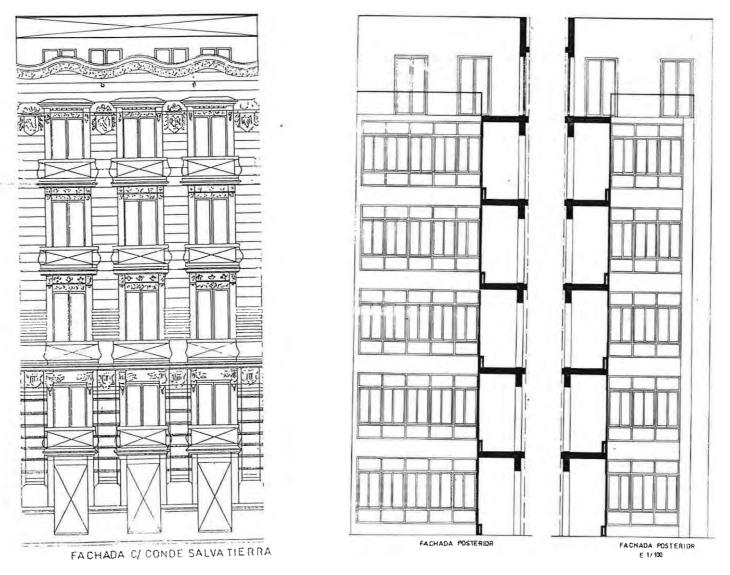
Fachada Posterior estado proyectado, C/ Conde Salvatierra , rehabilitación 1985
